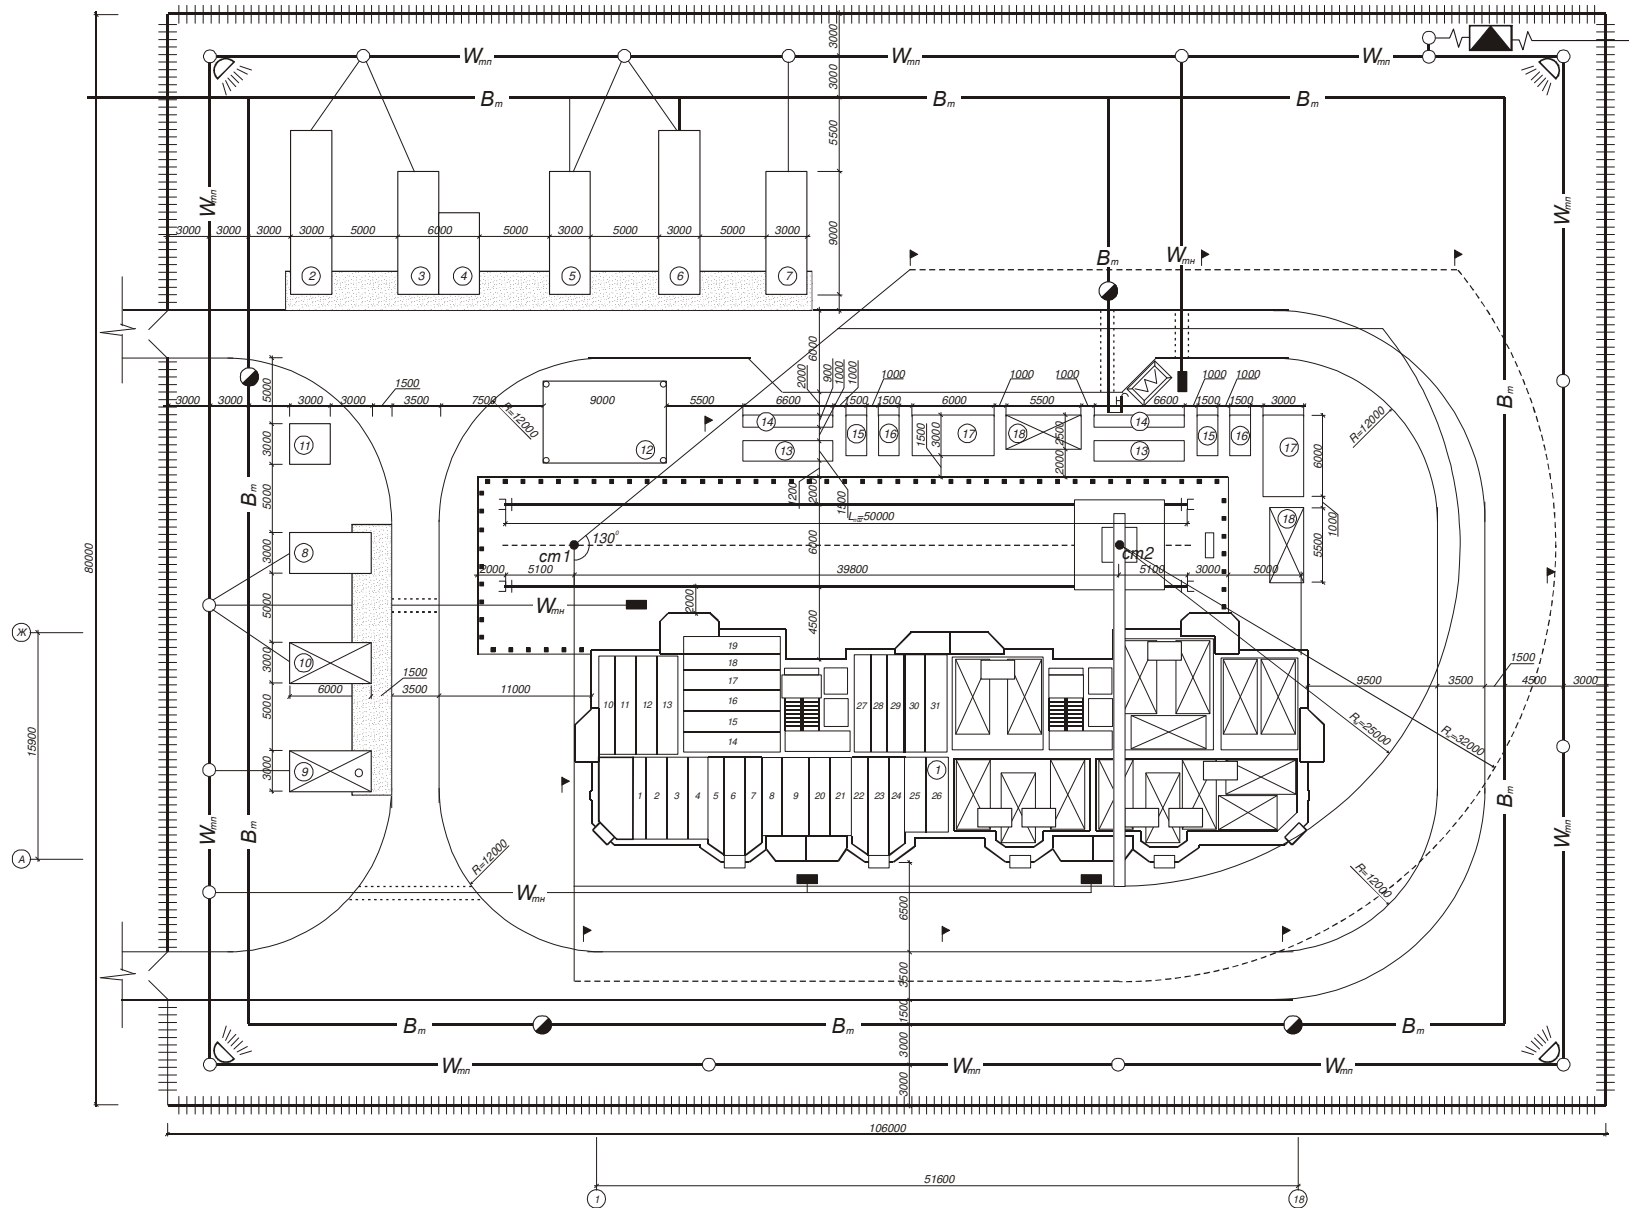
Будівельний генеральний план будівництва житлового багатоповерхового будинку
